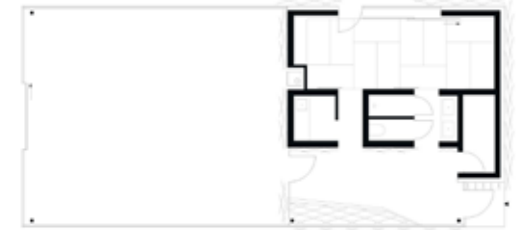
Grundriss Meditationshaus Kranzbach
